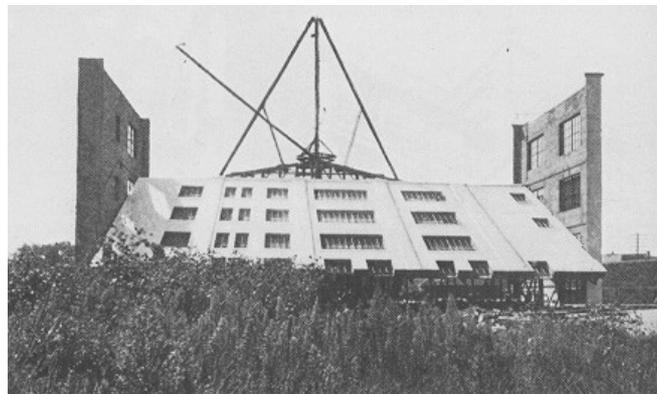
Fábrica construída com pré-moldados em Rogers Park, Illinois, 1911
